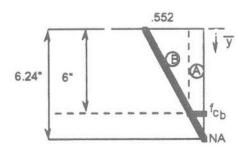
B.7-2—Diagrama de tensión del concreto para la porción de losa de viga en T, nts
